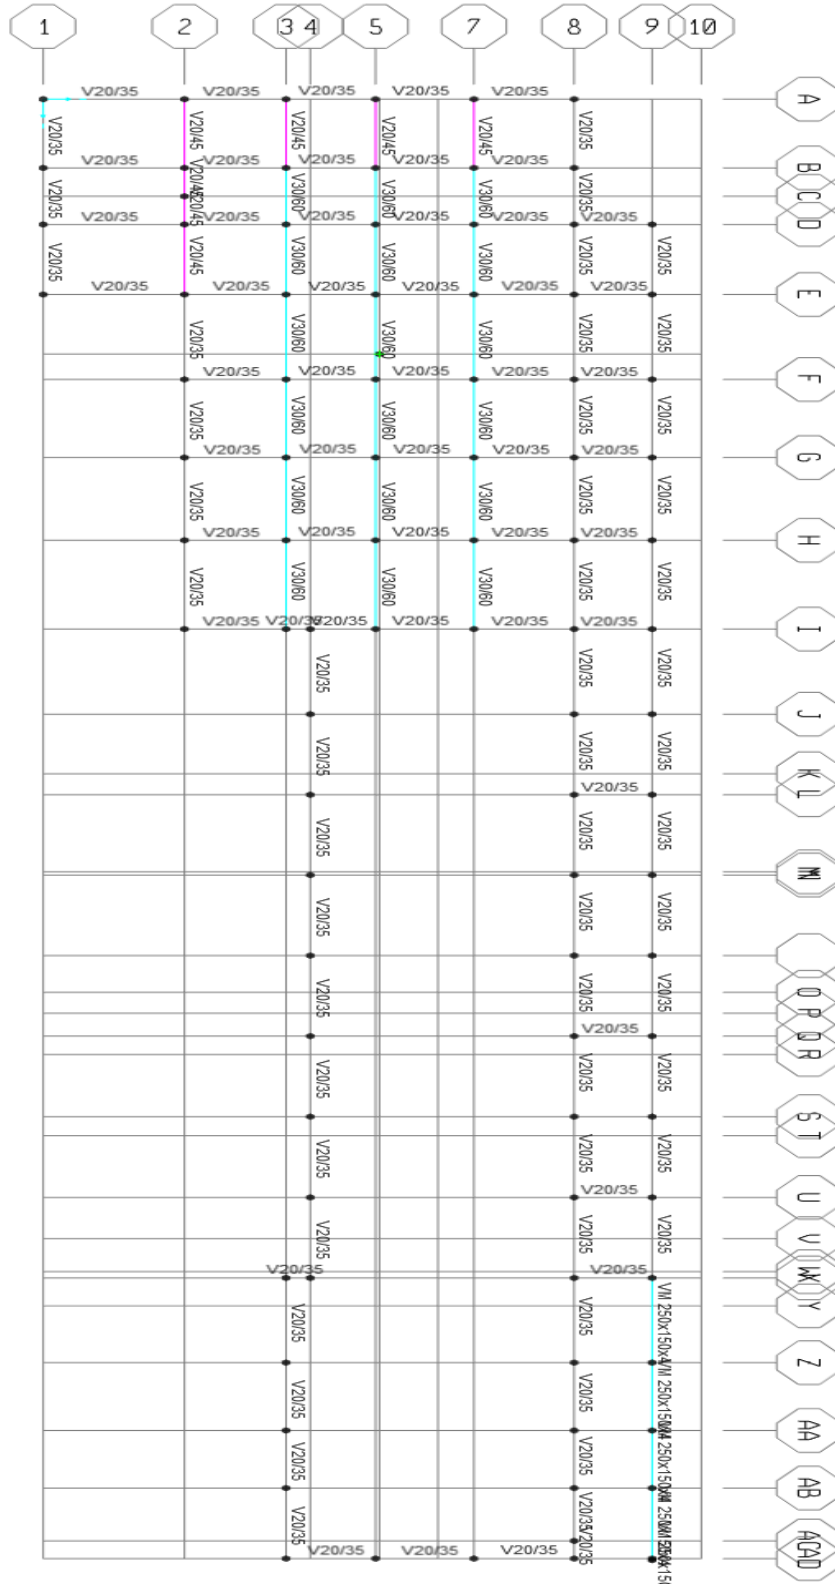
Vista de planta de cubierta del bloque B del Vicente Rocafuerte.
